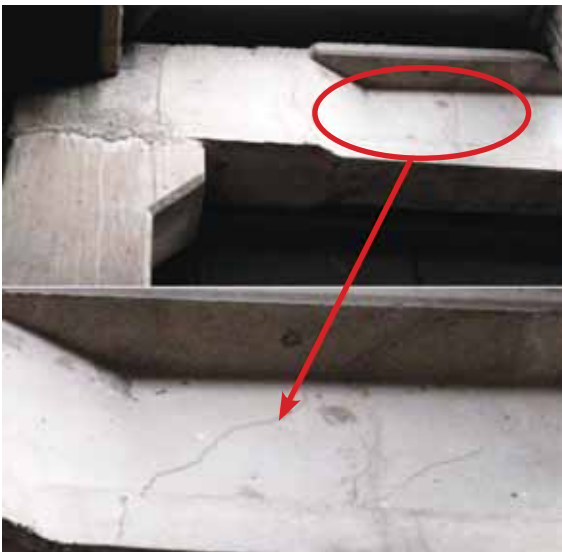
Fisuras debido al corte inducido por el giro del nudo continuo.
